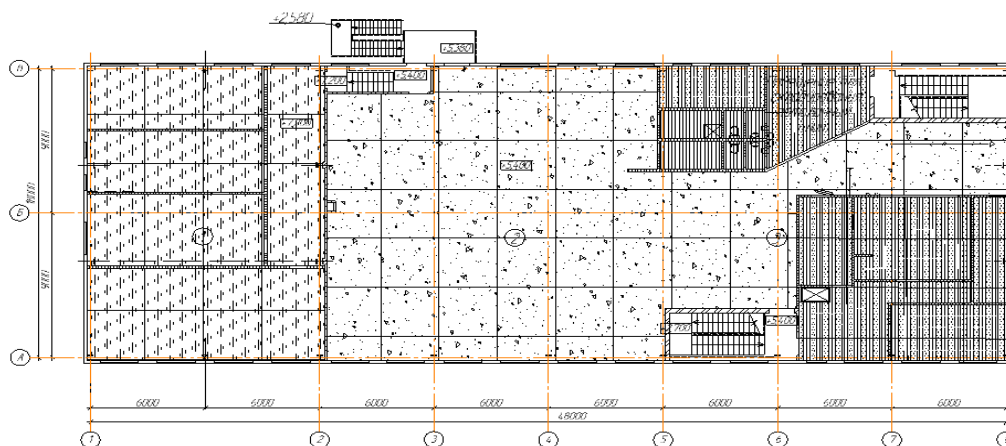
План размещения подвесных потолков 2 этажа
